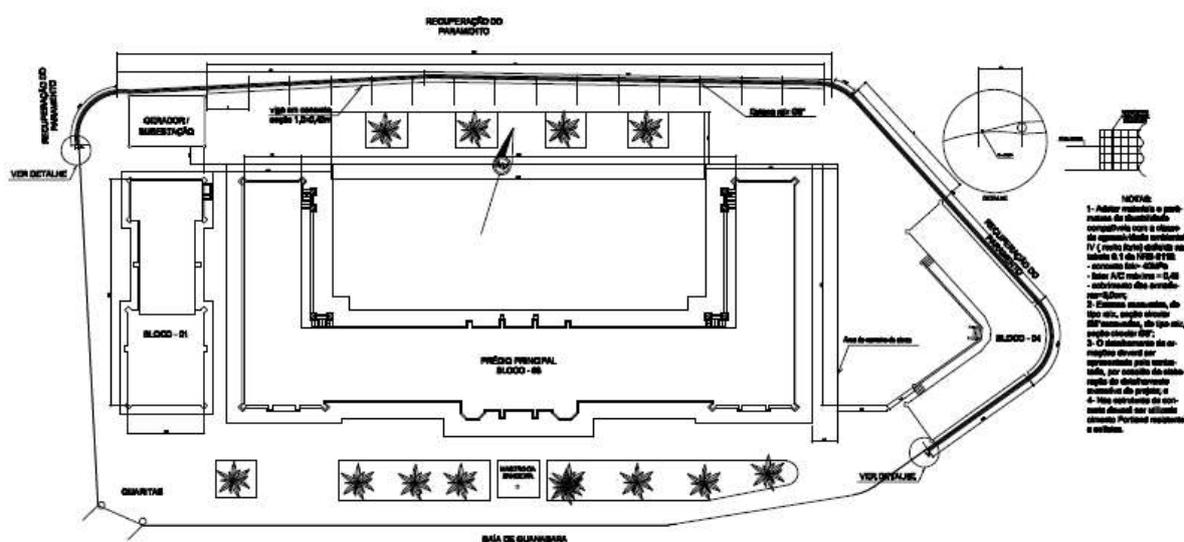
Planta de situação. Delimitação do perímetro de recuperação do cais.
